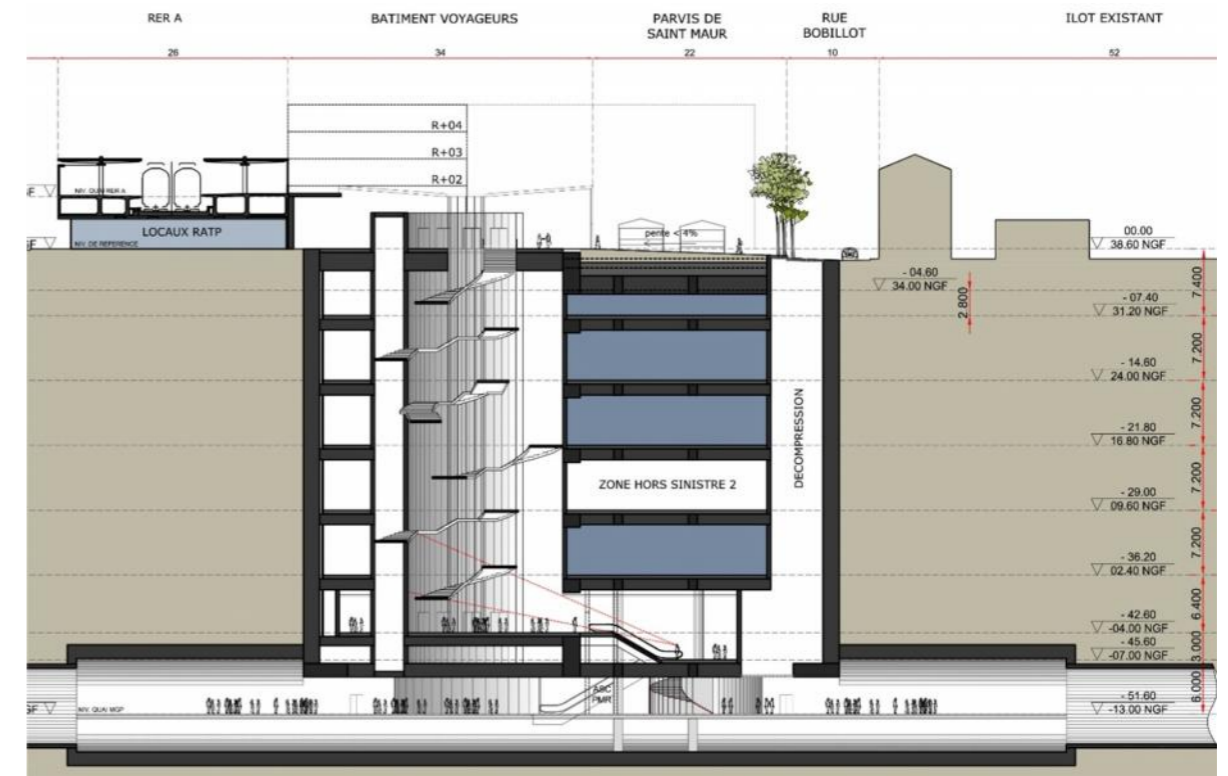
Coupe longitudinale de la gare – présentation des niveaux de dalles
